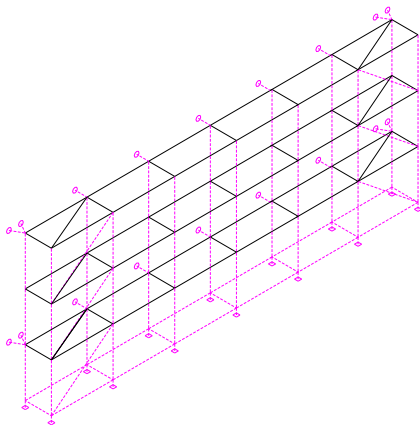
Horizontale Verstärkung bei Holzplattformen
